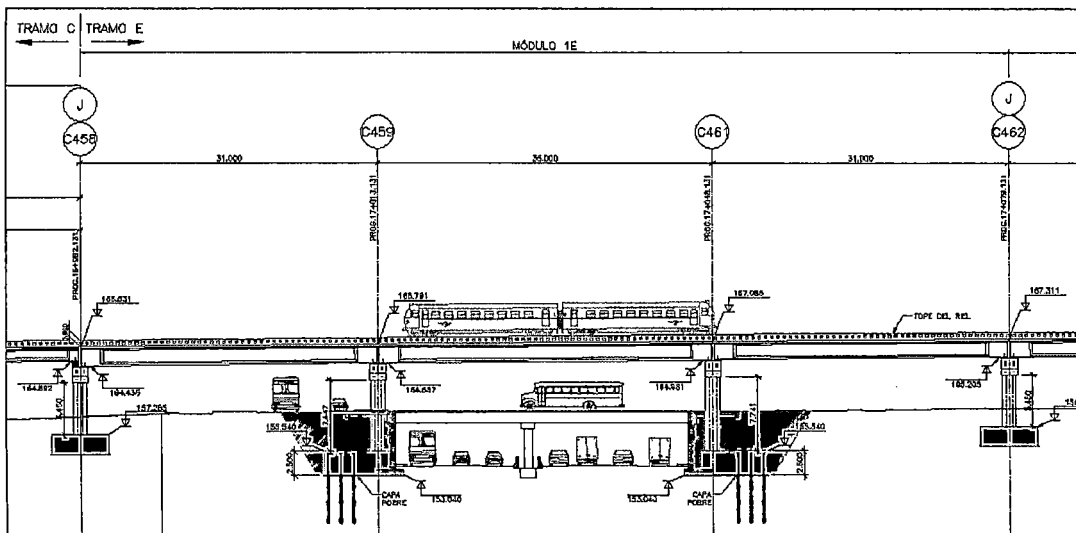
Vista de la elevación de Viaducto elevado cruce Javier Prado
